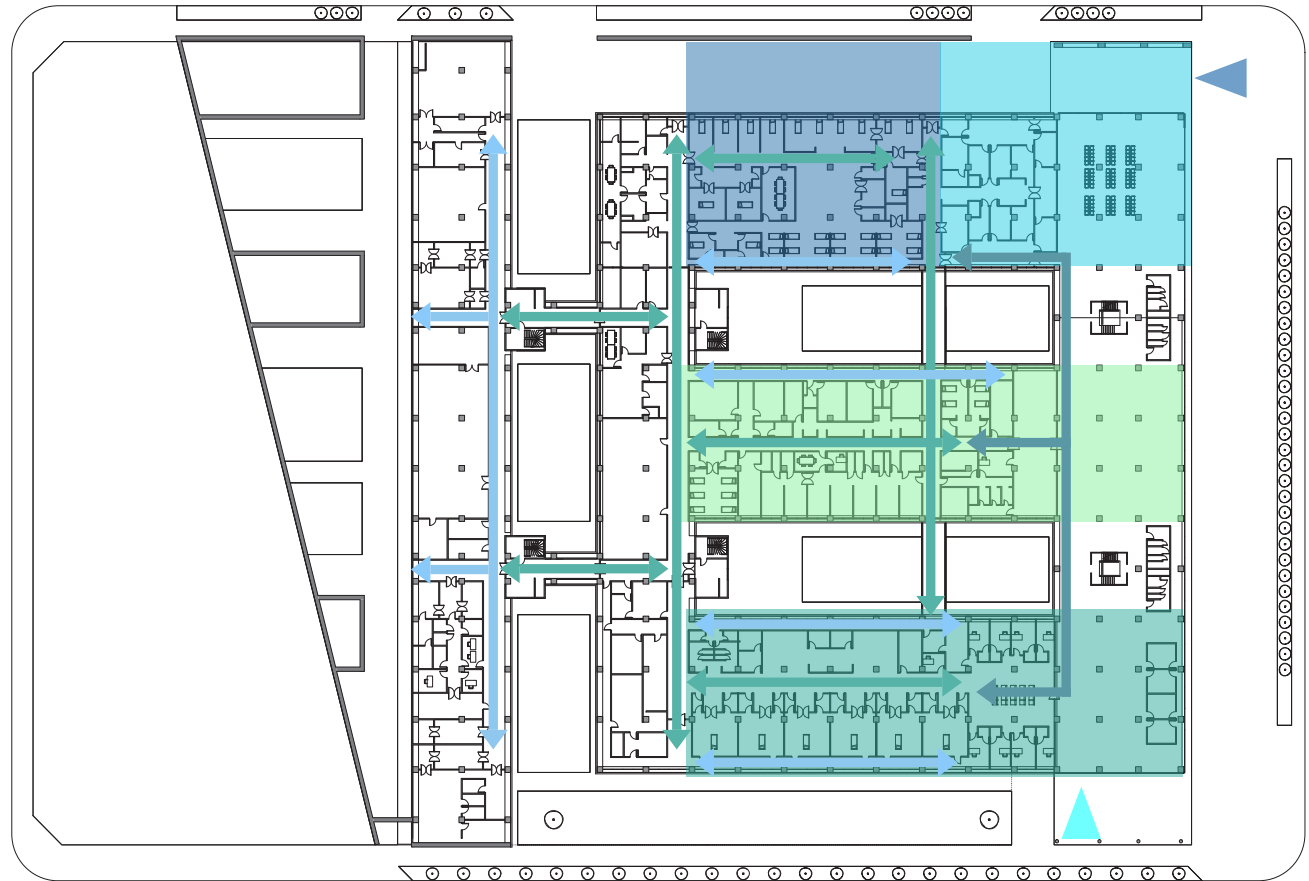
| Plano Arquitectónico (Autores,2020).
